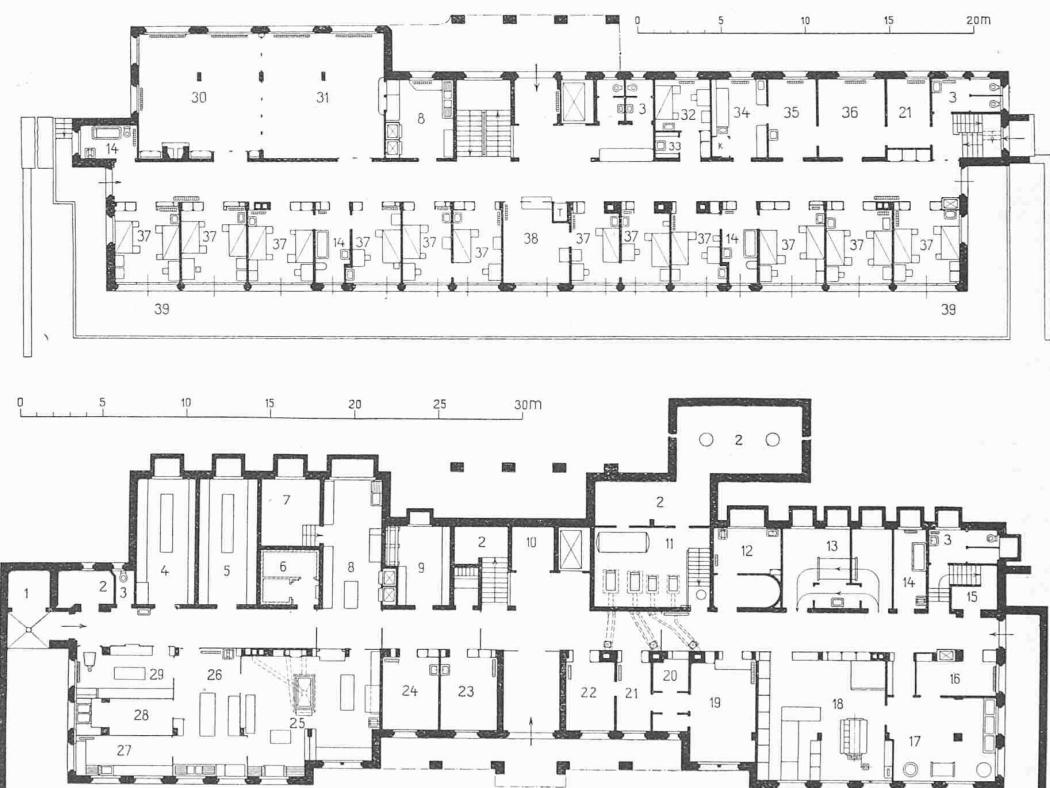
und 2. Grundrisse vom Untergeschoss und Erdgeschoss, — Maßstab 1 : 400.
